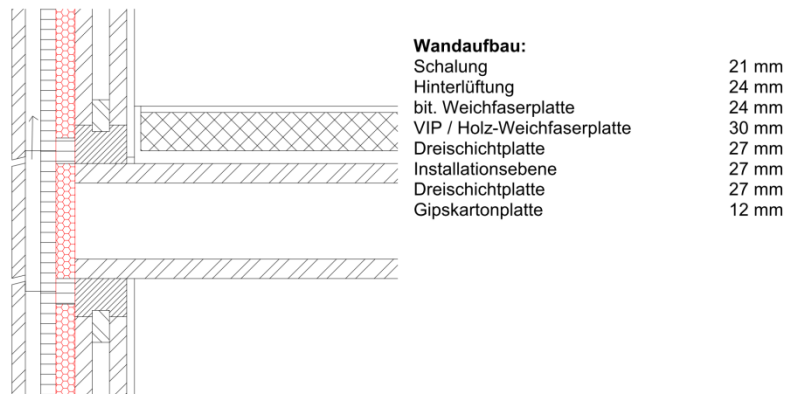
Detail Holzelementbau mit VIP. Querschnitt durch das Deckenaufleger.
